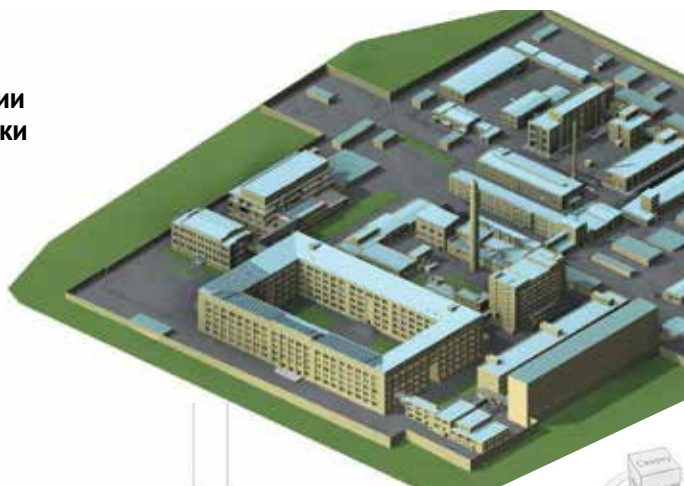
3D-вид компоновочных решений корпуса 8
